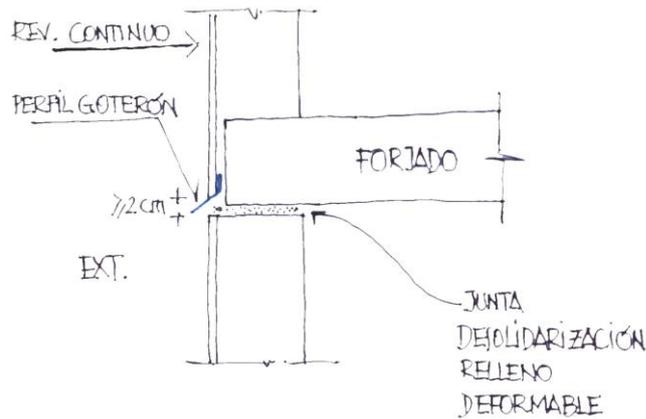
Esquema de encuentro fachada – forjado
